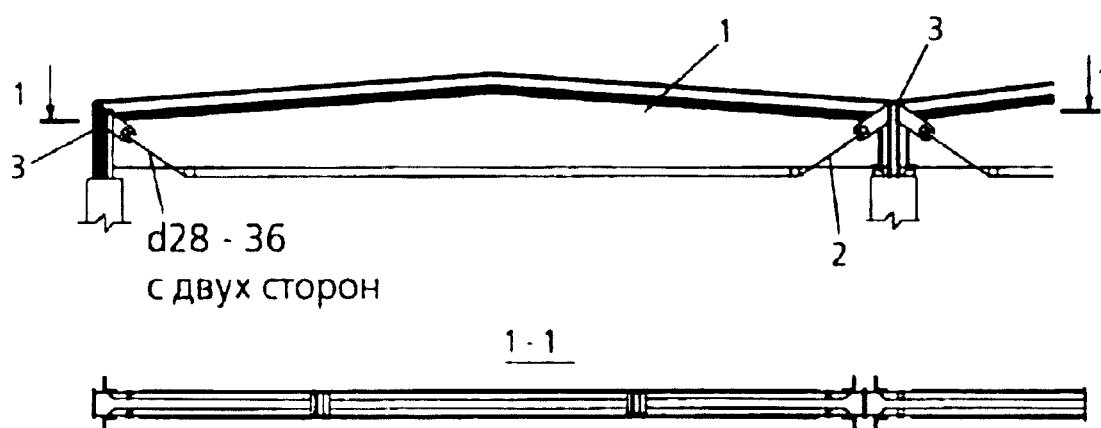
Схема усиления балки напрягаемой шпренгельной затяжкой: 1 - усиливаемая балка; 2 - шпренгельная затяжка из двух арматурных стержней; 3 - торцевая упорная деталь
